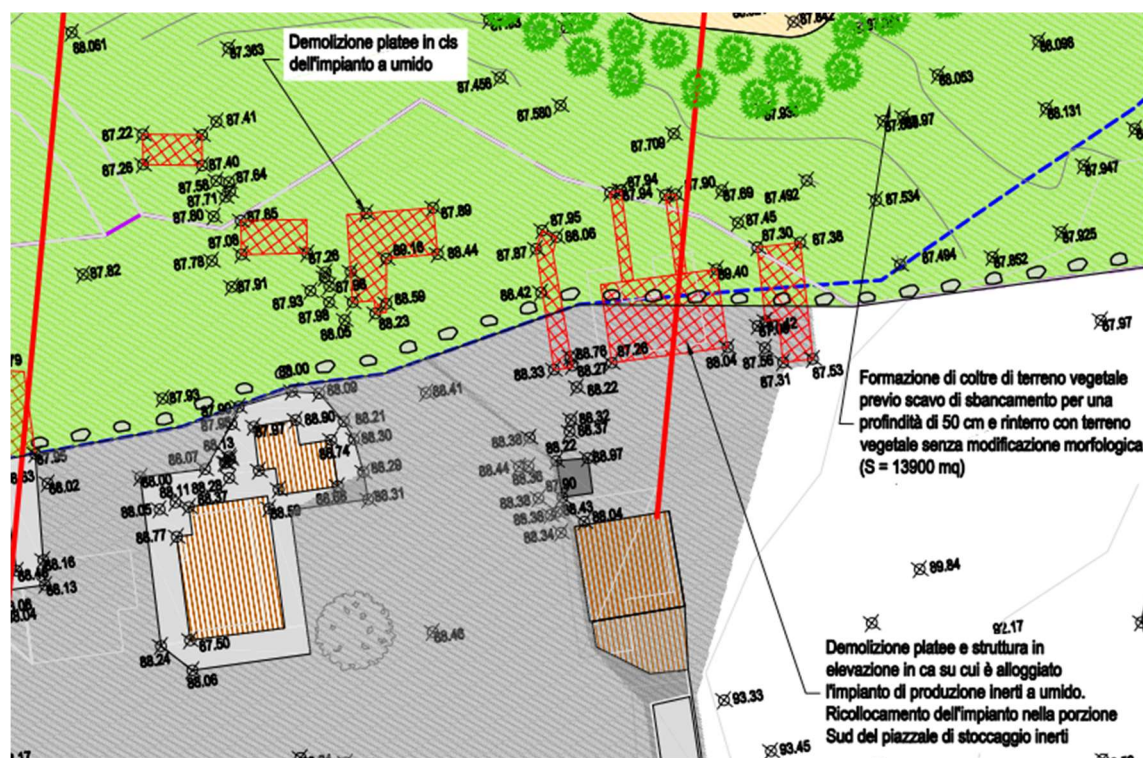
Estratto tavola 2A Planimetria di Progetto Stato Variante Stralcio 1 dove si evidenzia la rimozione allestimenti impianto trattamento inerti a umido (in alto) e la nuova collocazione allora prevista (in basso)
